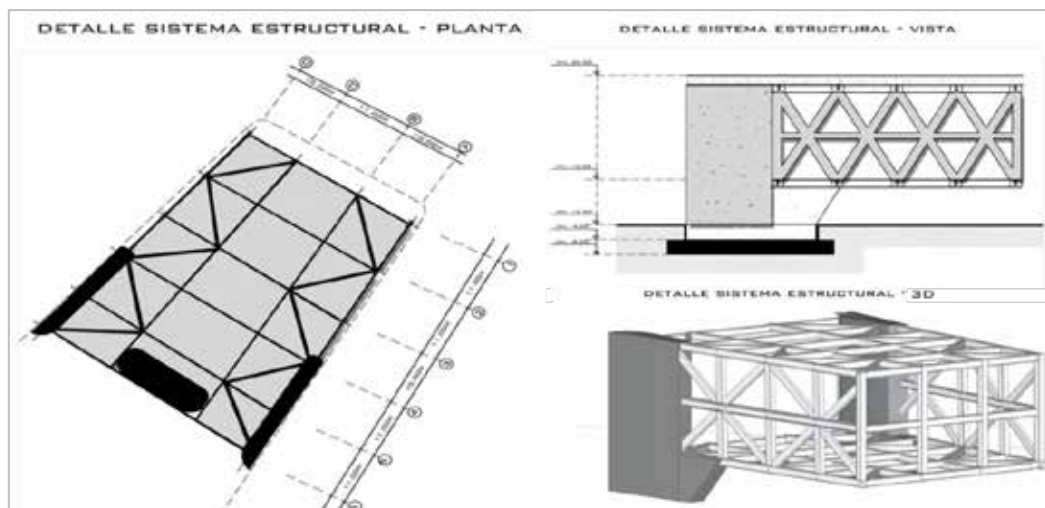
Vistas del Sistema estructural del Volado del Edificio Este. Fuente: perales 2020
